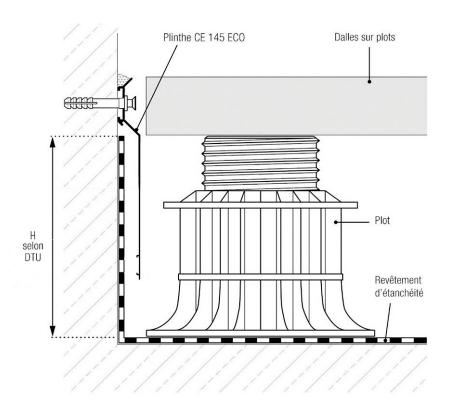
Toiture-terrasse accessible aux piétons et au séjour avec dalles sur plots et niveau fini des dalles au-dessus du haut des relevés avec Plinthe CE 145 ECO
